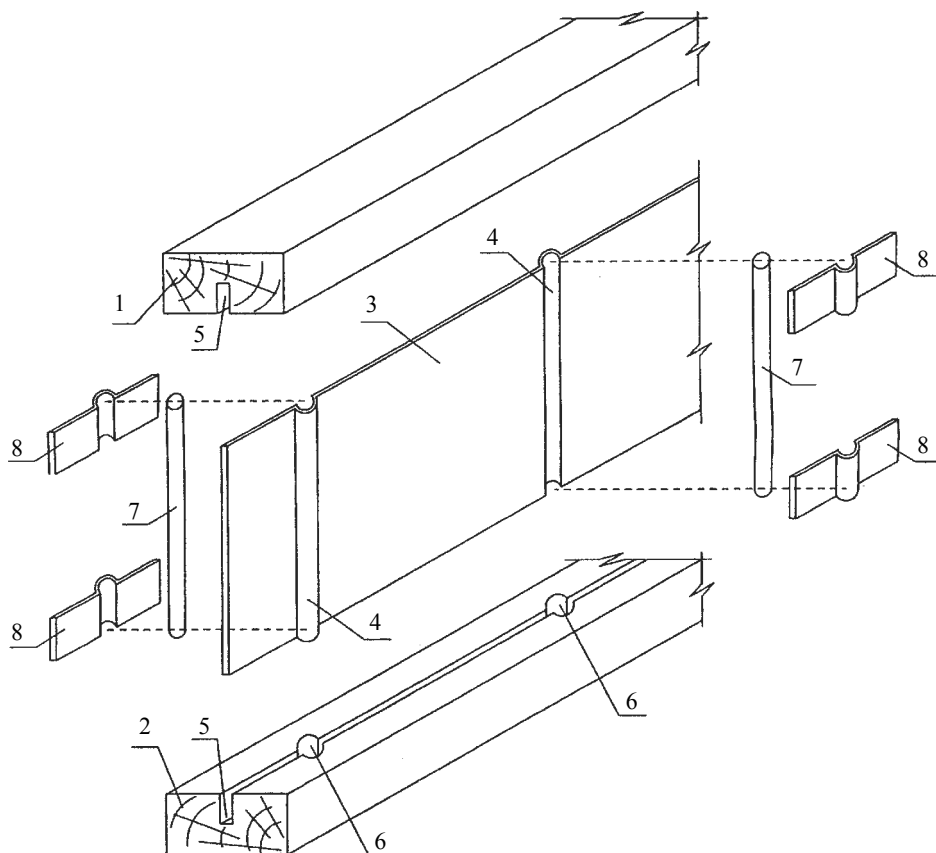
Конструкция металлодеревянной двутавровой балки: 1 – верхний пояс; 2 – нижний пояс; 3 – стальная стенка; 4 – гофры полуцилиндрической формы; 5 – продольный пропил; 6 – углубления цилиндрической формы; 7 – цилиндрические нагели; 8 – плоские участки стенки
